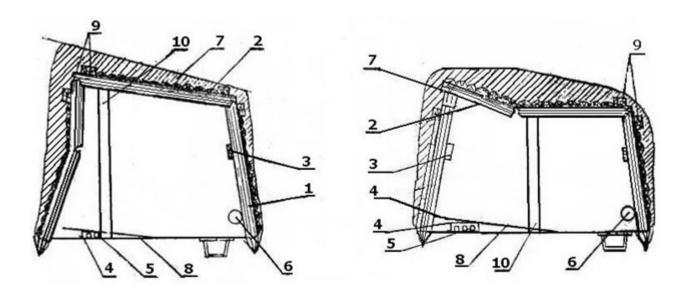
Замена элементов крепи Условные обозначения: 1 — стойка; 2 — верхняк; 3 — расшивка; 4 — швеллер (рештак); 5 — кабели; 6 — трубопровод; 7 — зона разборки породы; 8 металлический лист; 9 — клинья; 10 — стойка усиливающей крепи
